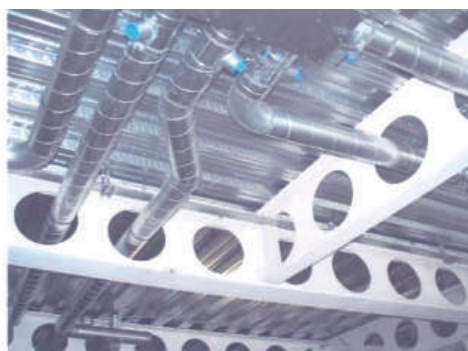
Përçarja e instalimeve nëpër hapjet të trave bartës së lastrave të lehtësuar
